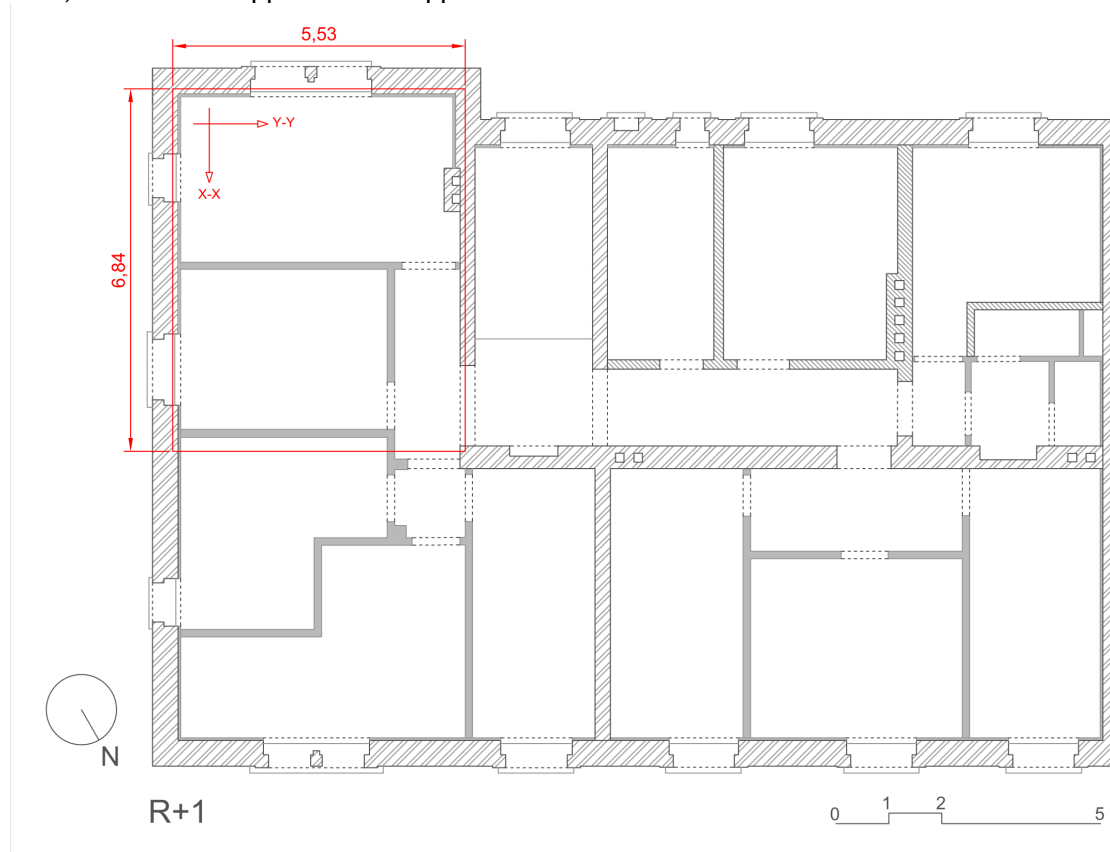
Plan du plancher étudié - ici plancher haut du R+1 - local de l'angle sud-est.
